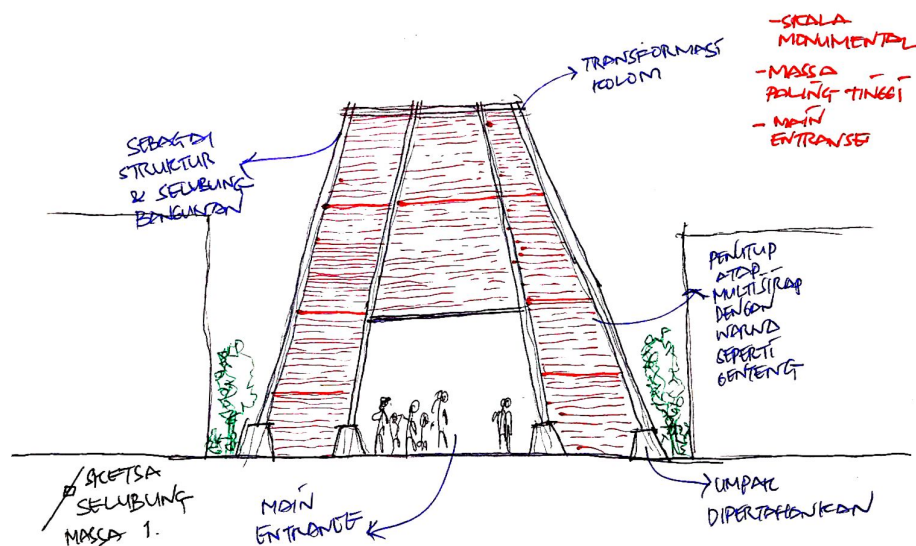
Penyelesaian Bentuk Bangunan
